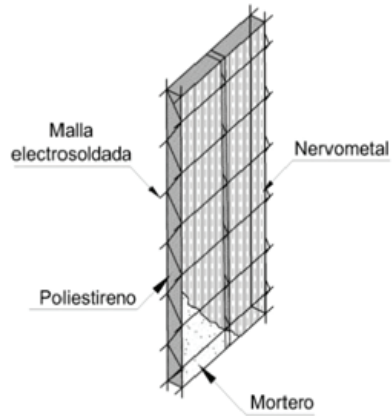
Sistema con Malla soldada con núcleo de poliestireno revestido con tol expandido ó malla hexagonal para adherencia y recubierto con hormigón ó mortero
